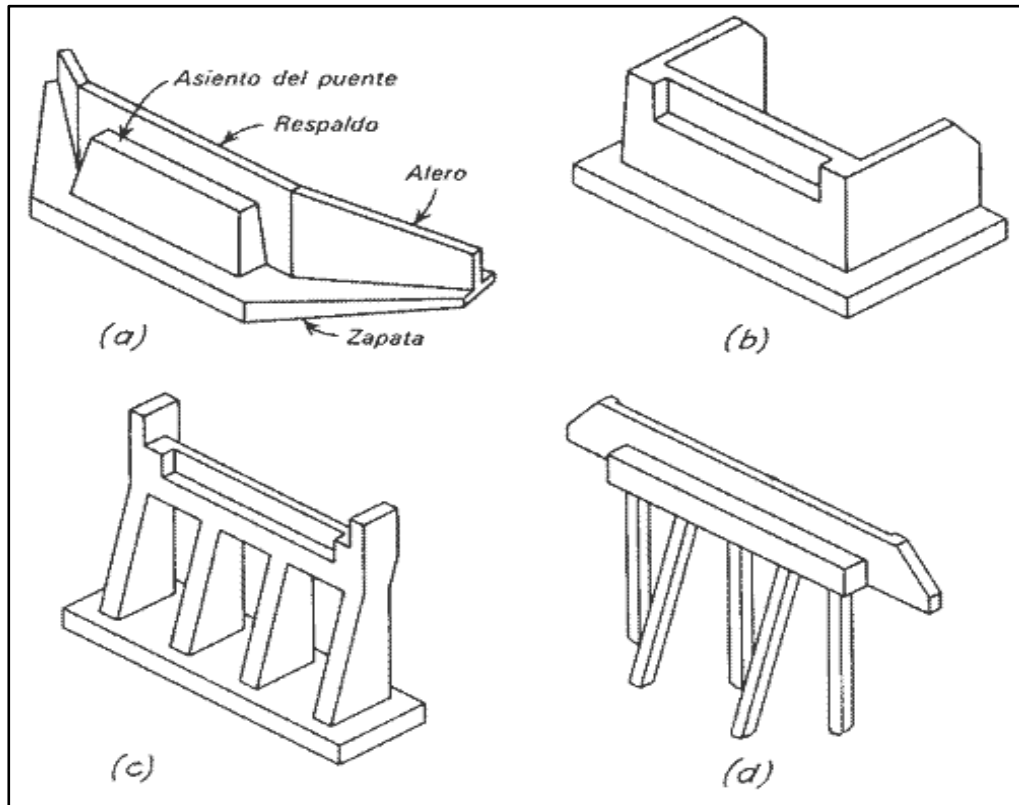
Tipos de estribos a) Estribo típico de gravedad con aleros b) Estribo en U. c) Estribo sin muro ni aleros d) Estribo de caballete con aleros cortos en cabezal.
